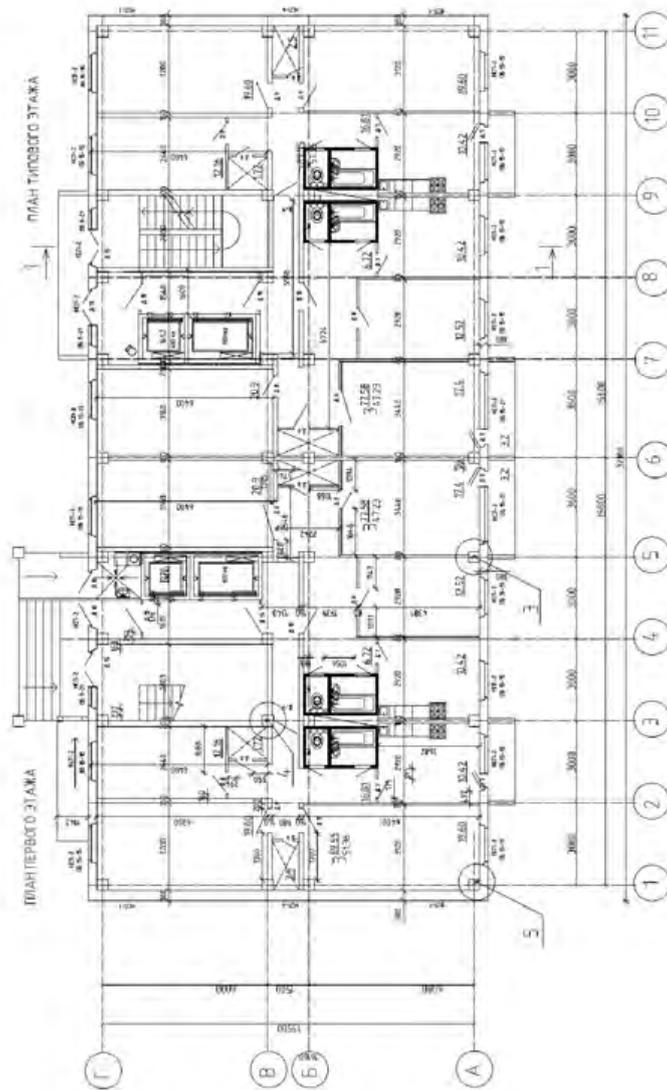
План первого и типового этажа каркасного жилого двухсекционного здания
